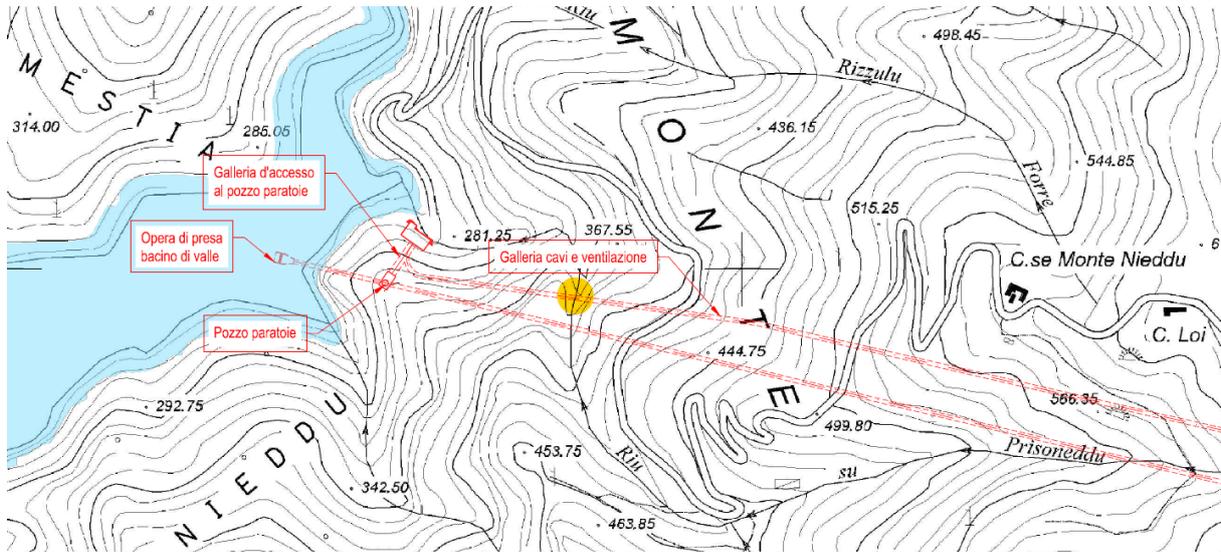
Galleria cavi e ventilazione (Planimetria di Progetto su base CTR Doc. 1351-A-FN-D-01-1)
